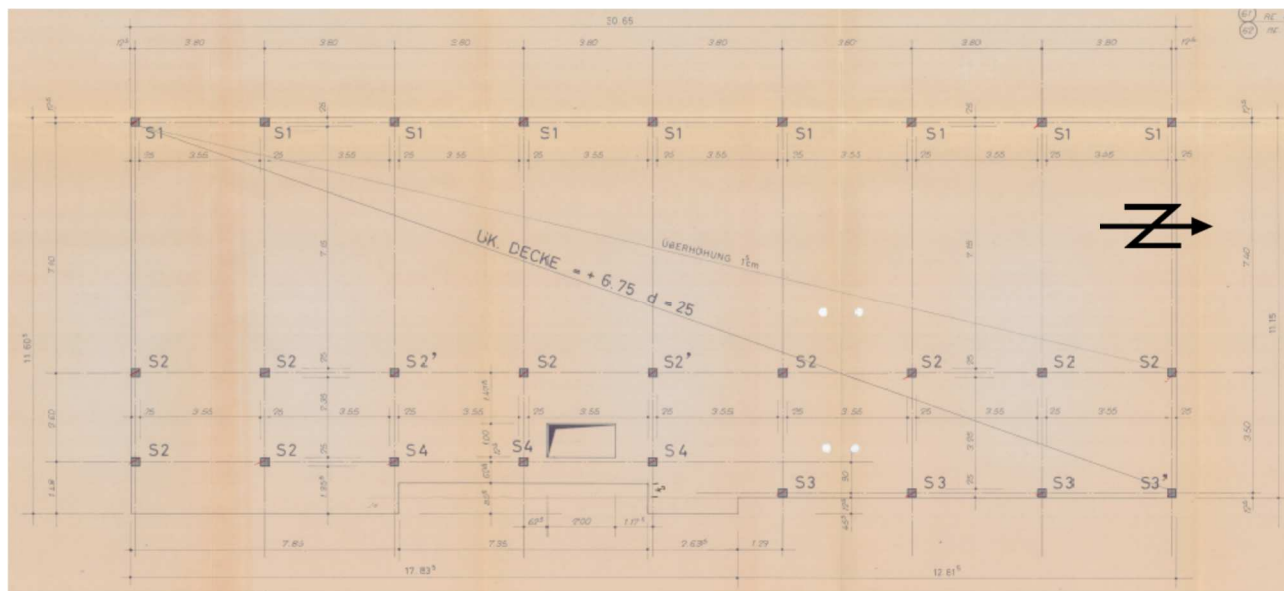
Grundriss Gebäudeteil 2, Schulgebäude Obergeschoss.
